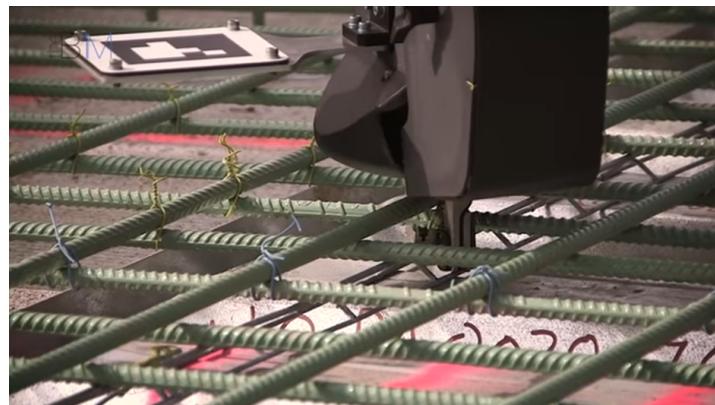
Execução de amarração de armadurta de laje com robô. Fonte: (TheB1M 2023).
